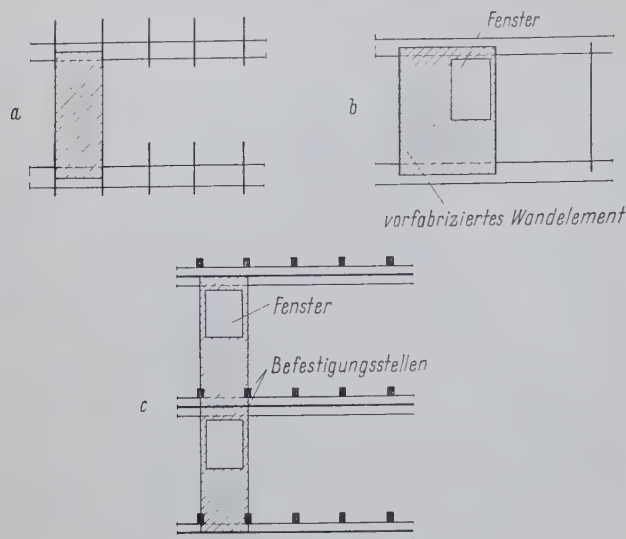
Grundformen der vorfabrizierten, selbsttragenden Wandelemente
